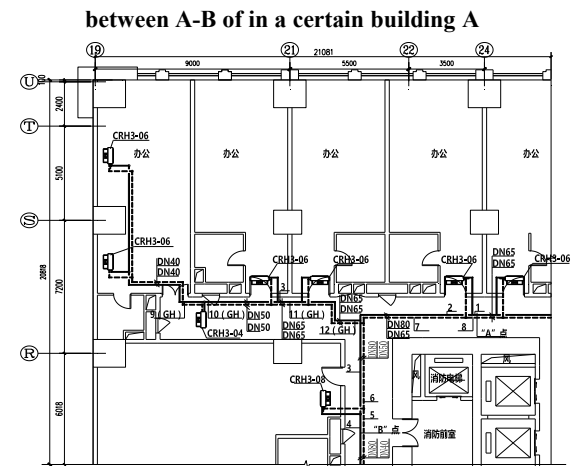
A 建筑某层空调水 A~B 管段局部修改平面图
